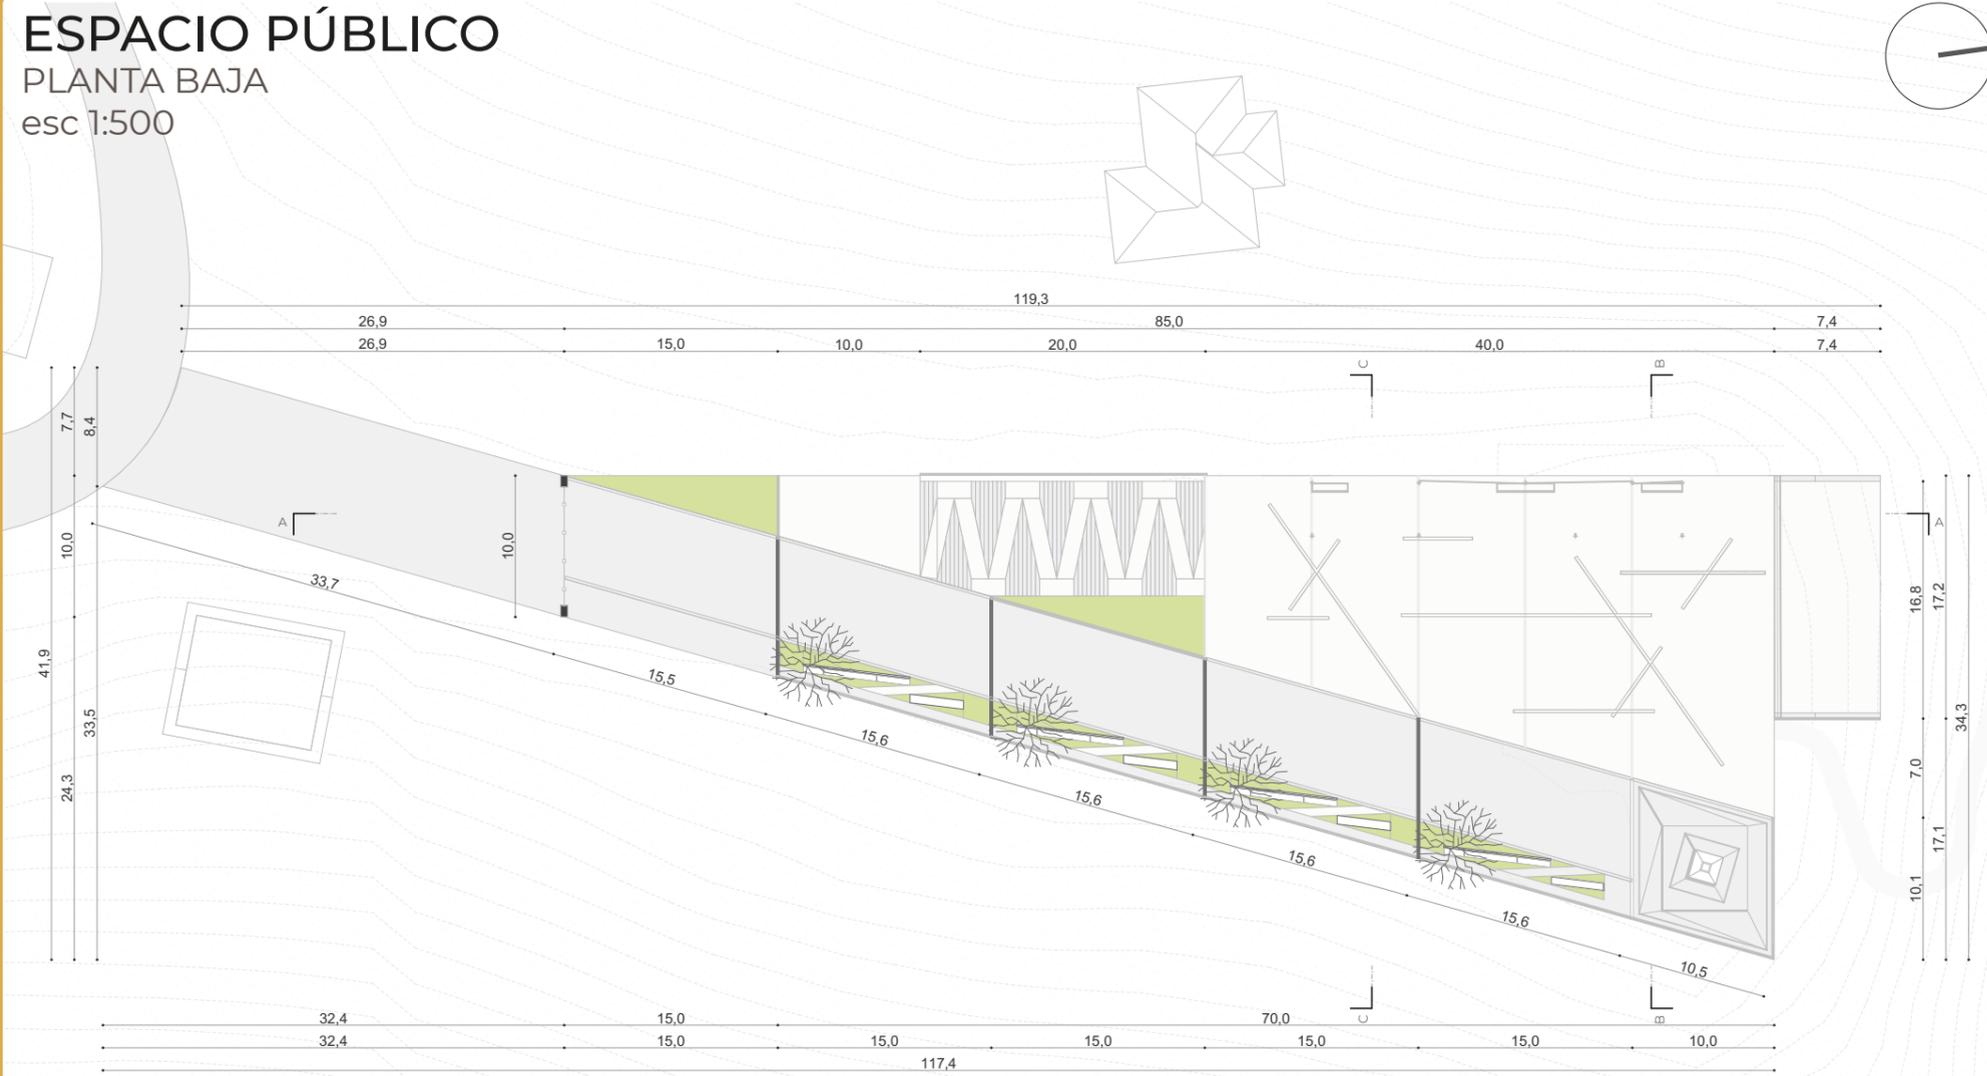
Planta arquitectónica del espacio público. Fuente: autores de la tesis (2020).
